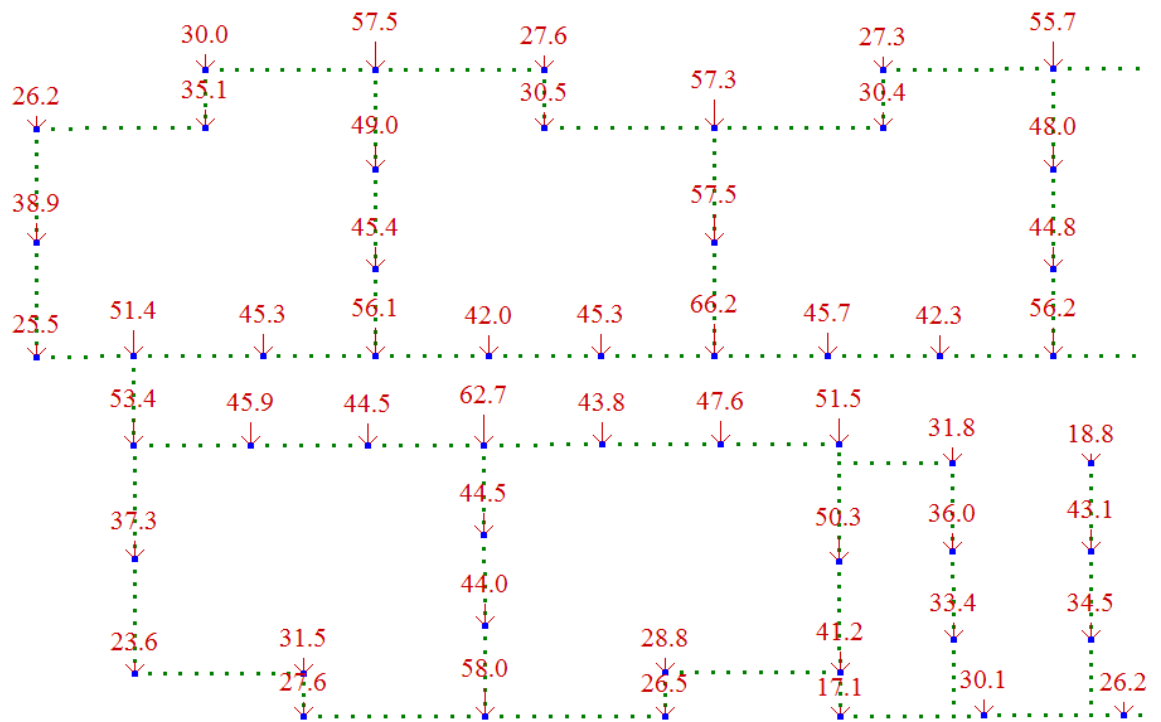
Вертикальная нагрузка в тоннах на свай в осях 1-8.
